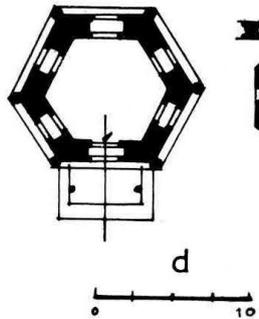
مسقط أفقي لتربة قره أحمد باشا في
